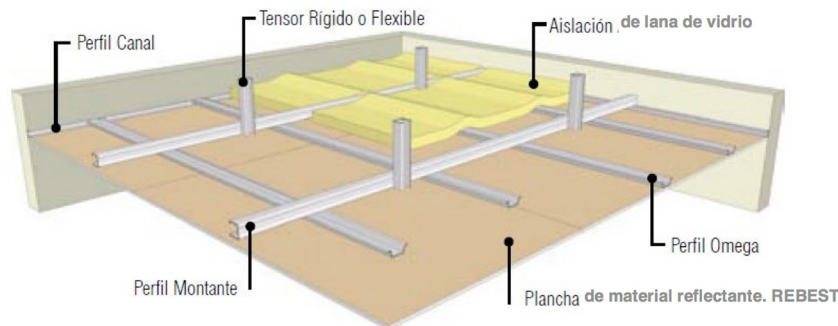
Detalle constructivo cielo raso. Vanessa Cruz 2014.
